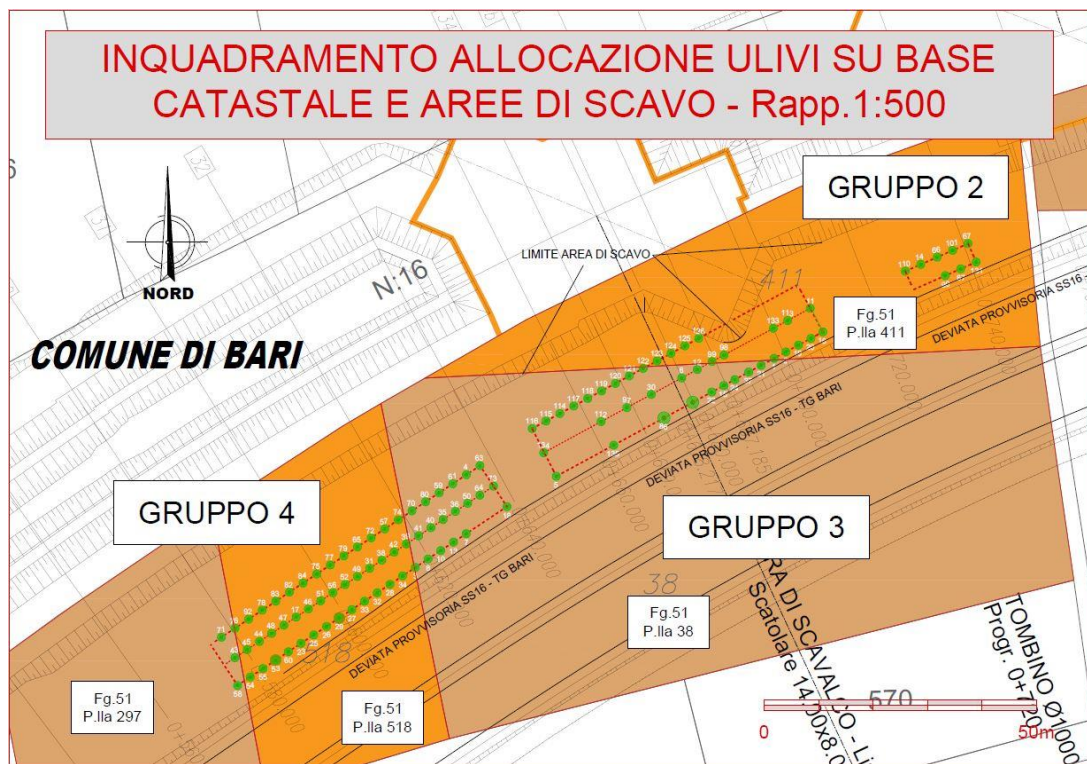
Planimetria attuale dei Gruppi 2, 3 e 4
